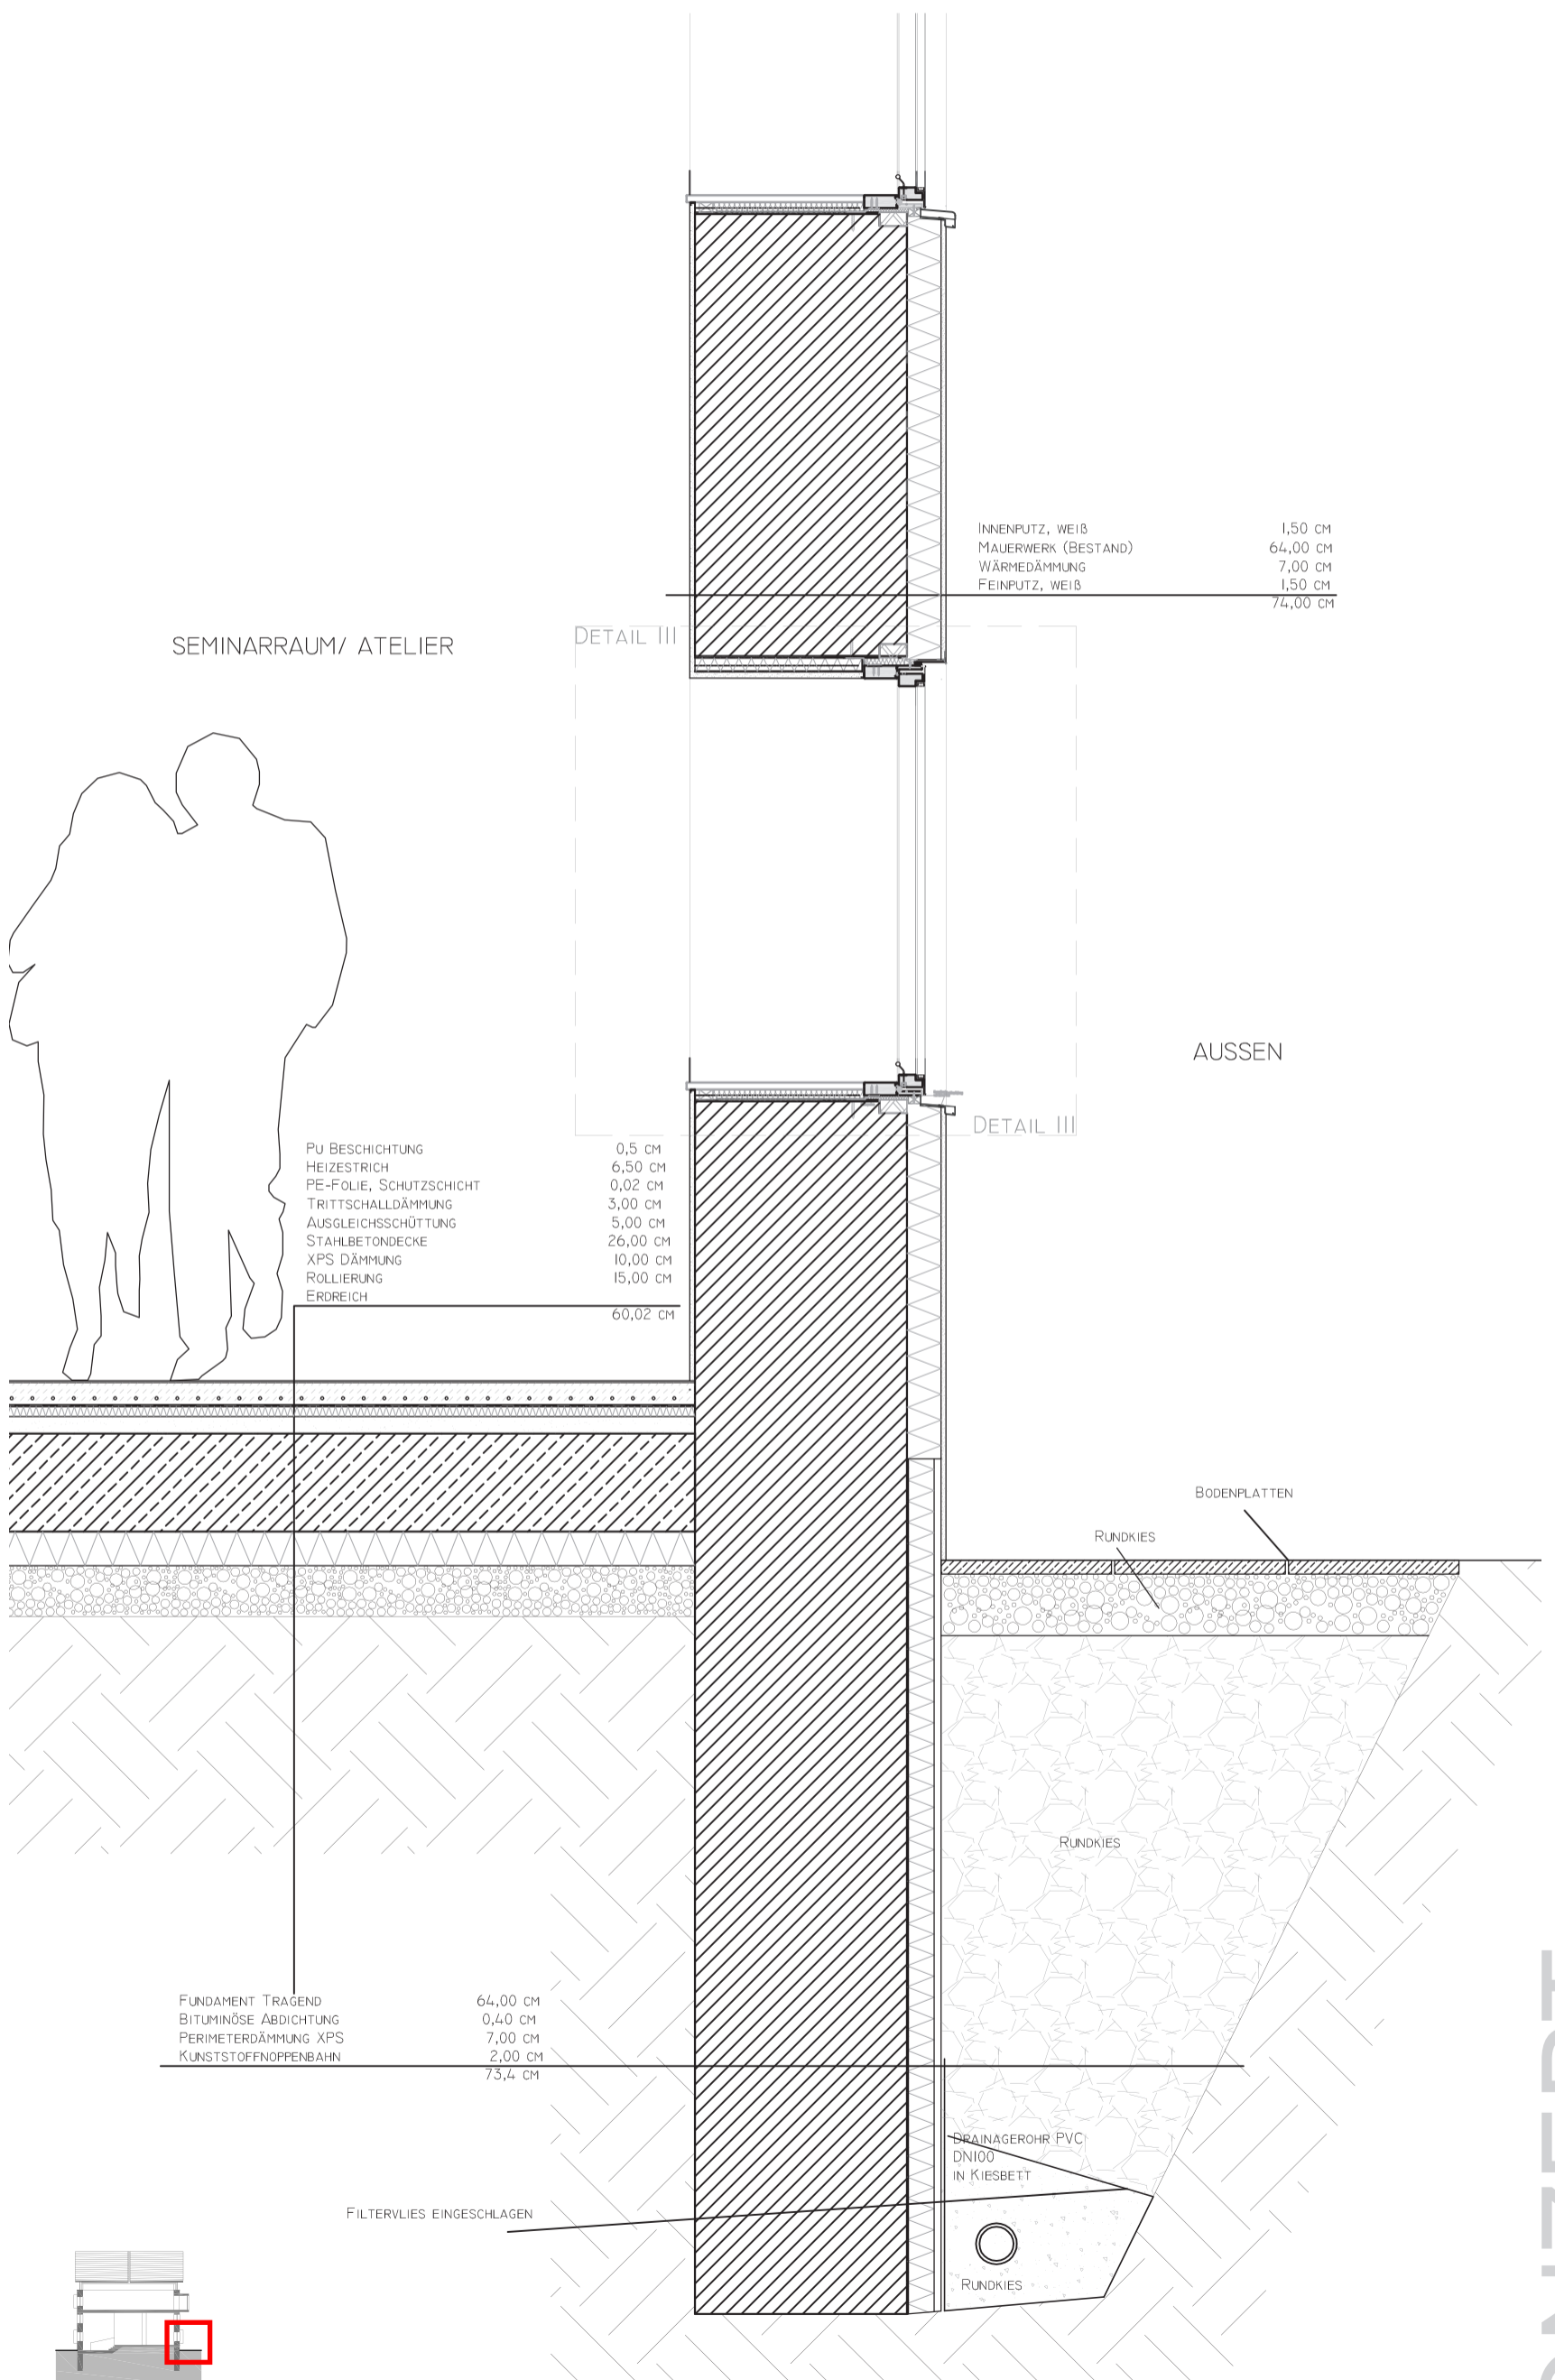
Schnitt Fassade unten, Sockel, 1:20
